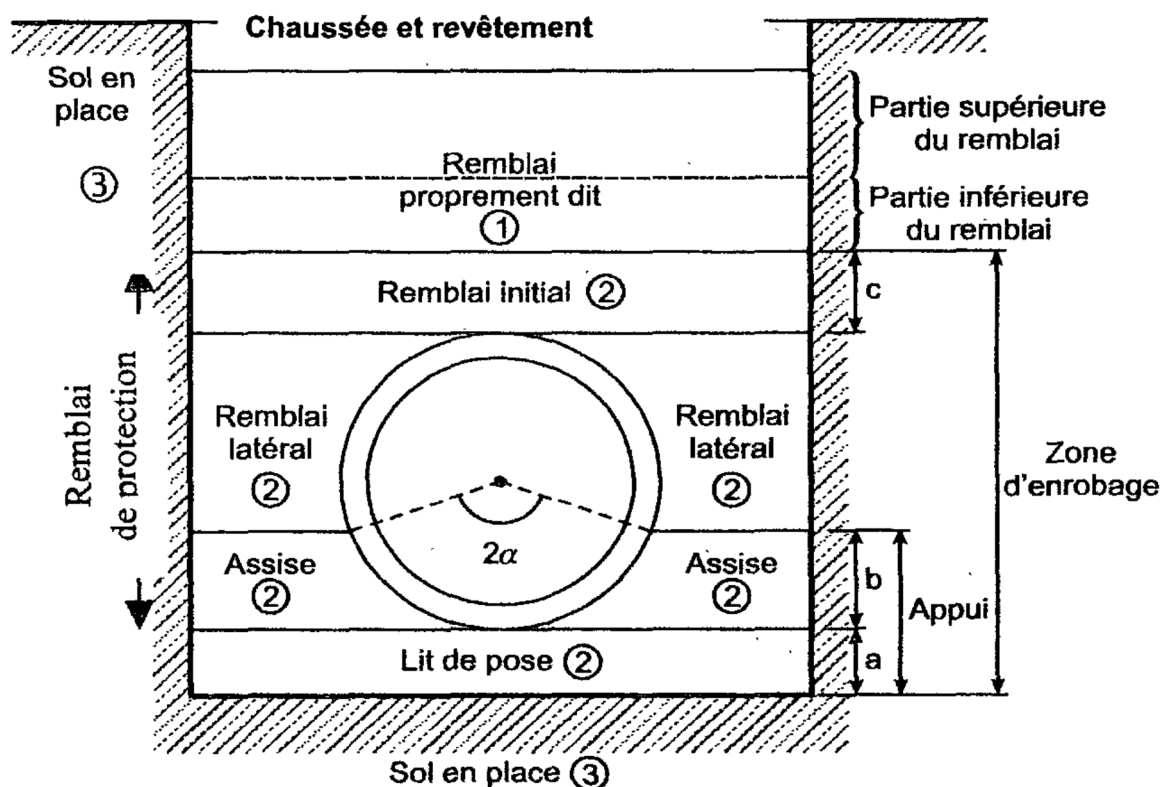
Coupe type de tranchée d'assainissement (Fascicule 70)
